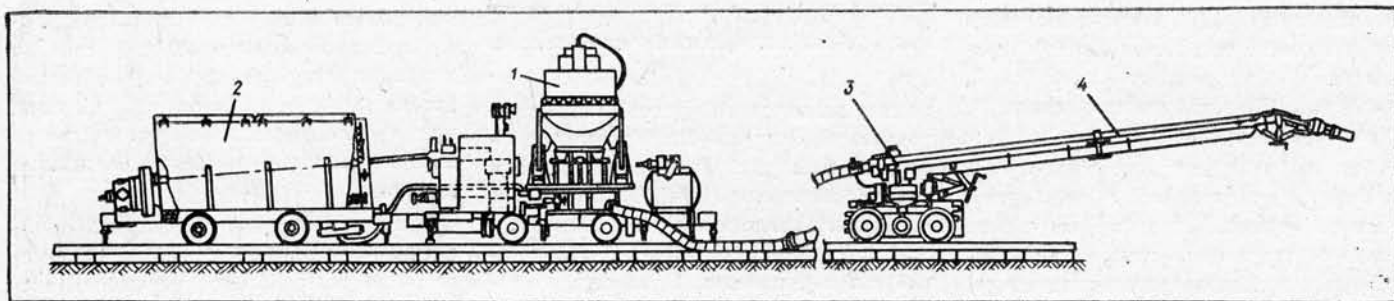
Общий вид комплекса «Монолит-2» (первый опытный образец)
